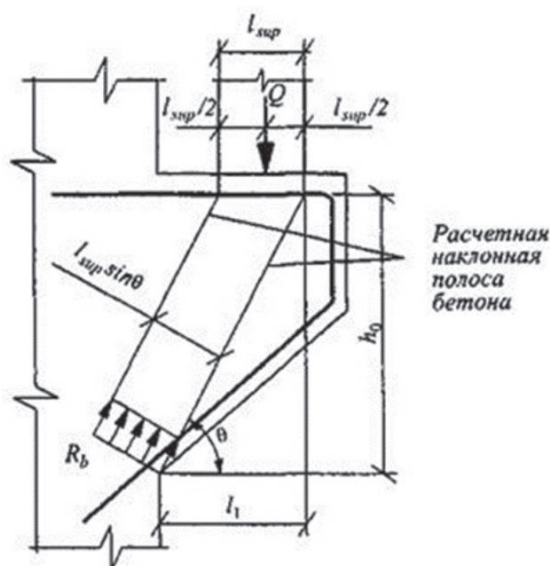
Расчетная схема и конструирование основного армирования короткой консоли
